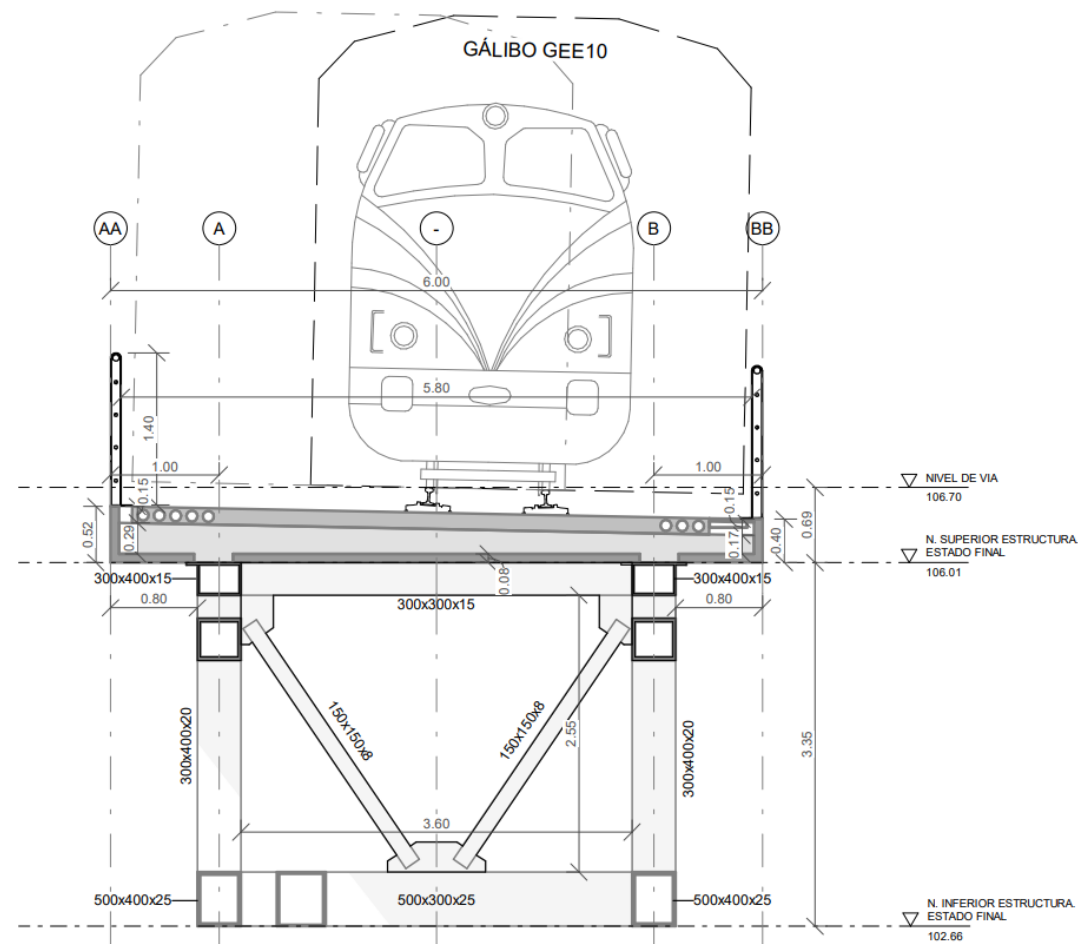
Sección transversal tipo del nuevo tablero.
